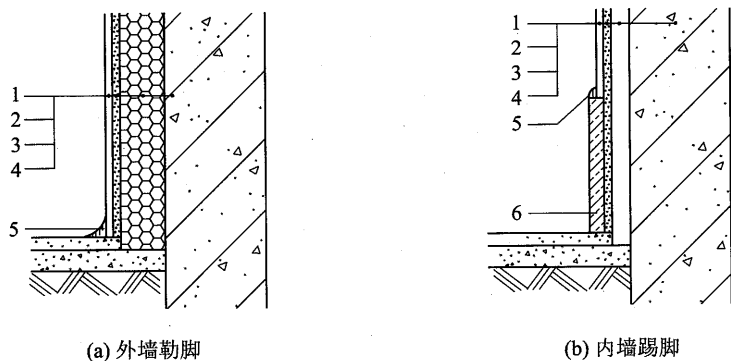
外墙勒脚及内墙踢脚收口构造示意
